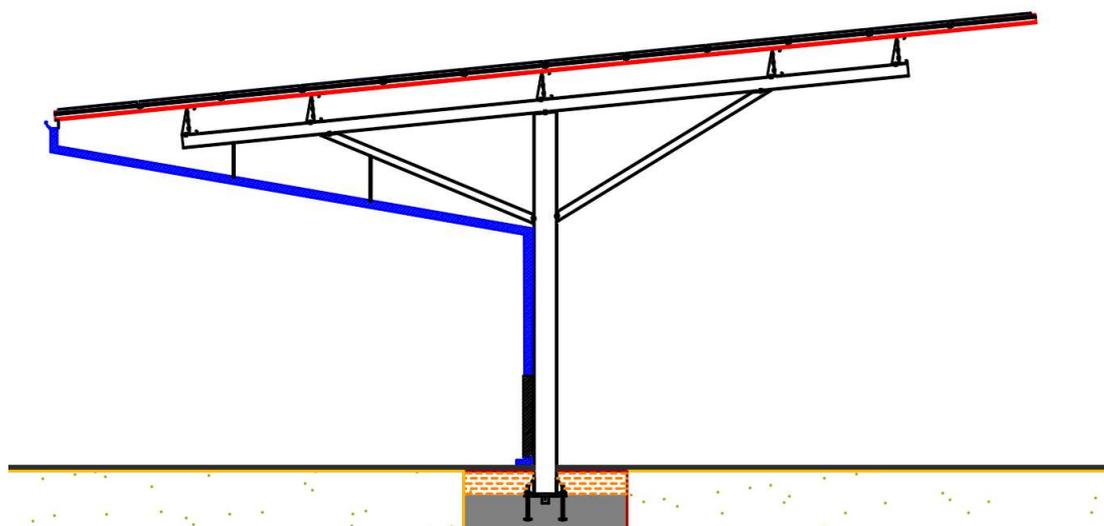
Vue en coupe d'une ombrière avec gouttière et descente d'eaux de pluie
